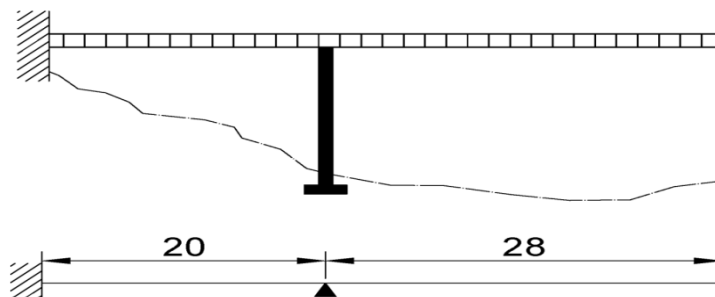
Esquema estructural de la fase constructiva modelada.
